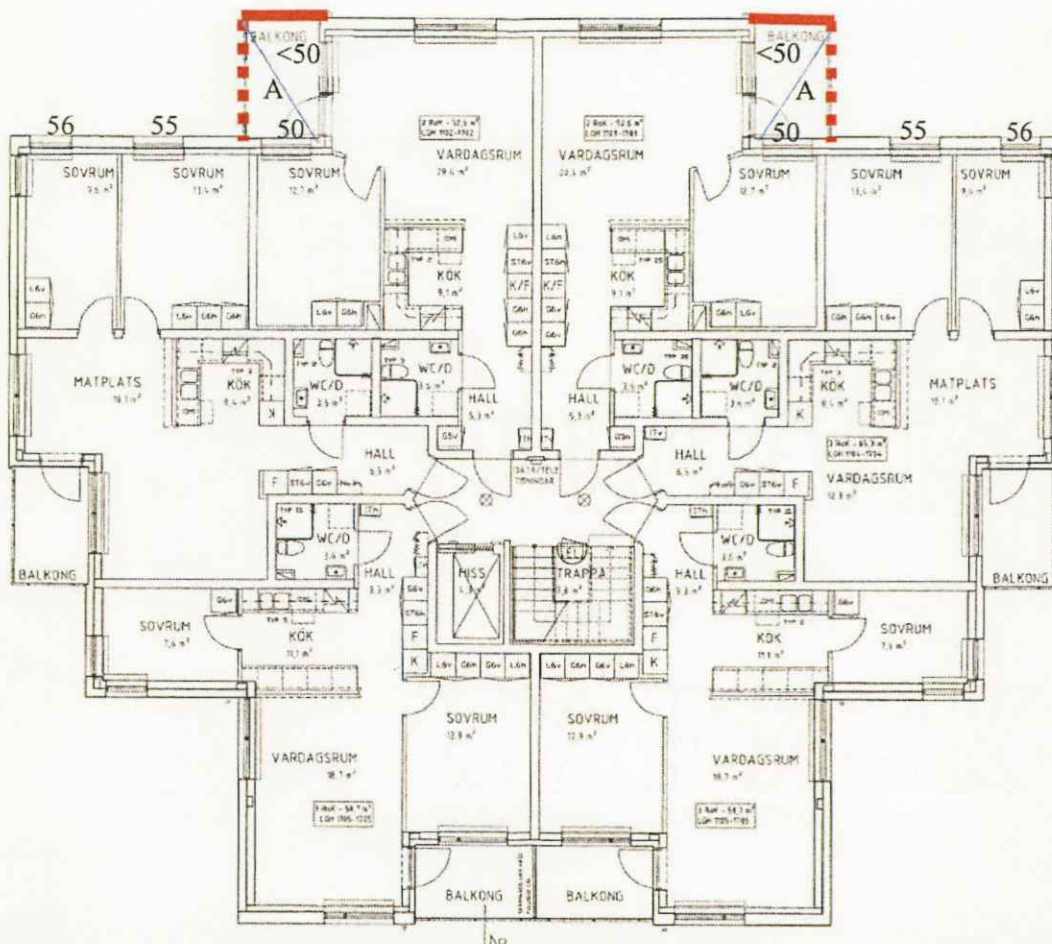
Beräknade ekvivalenta nivåer vid fasad efter förlängning av garage för plan 1 -7.
